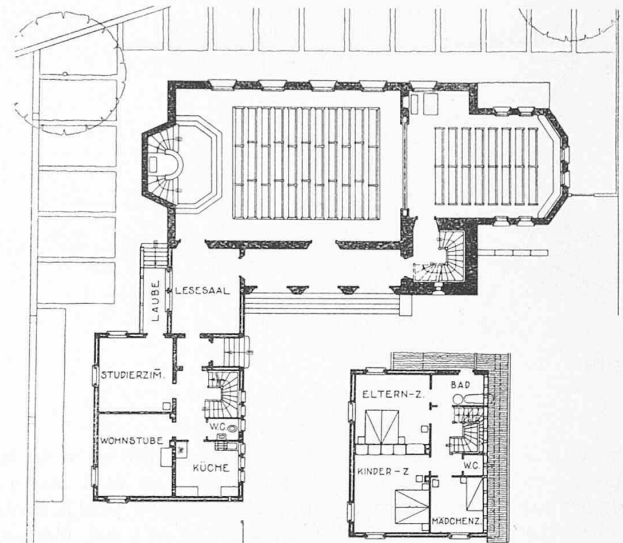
Grundrisse von Kirche und Pfarrhaus. — Masstab 1 : 400.
